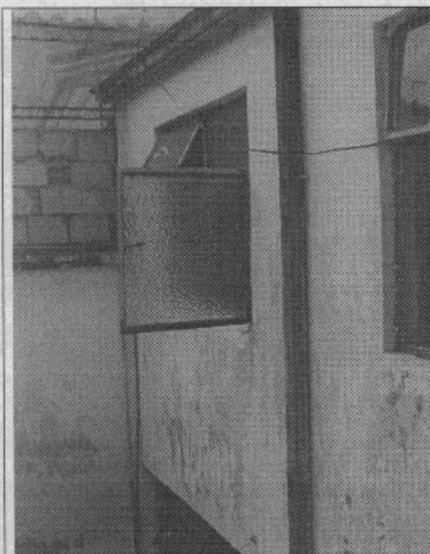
Vista de la fachada interior del predio inspeccionado; desprendimiento del acabado del muro.
